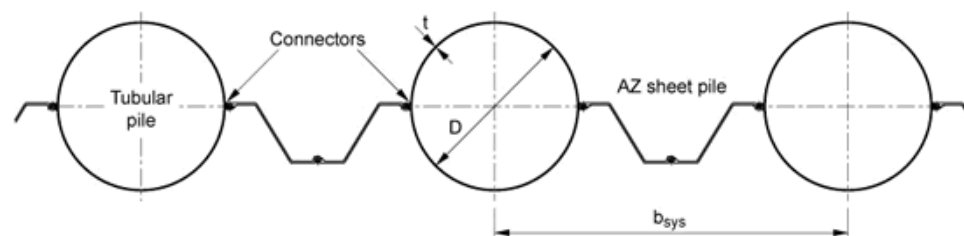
Arrangement typique –Rideau mixte pieux / palplanches
